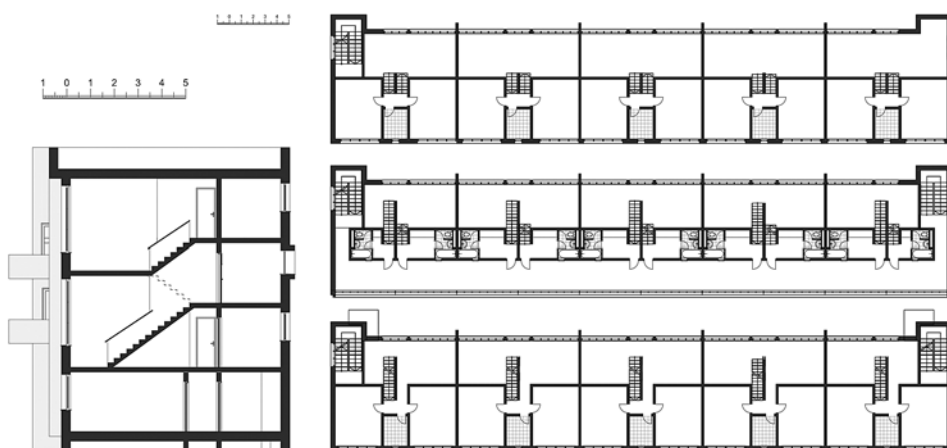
Поперечный разрез и планы 2, 3 и 4-го этажей жилого дома ВИЖ. Чертеж О.Ю. Швецово́й, 2023
